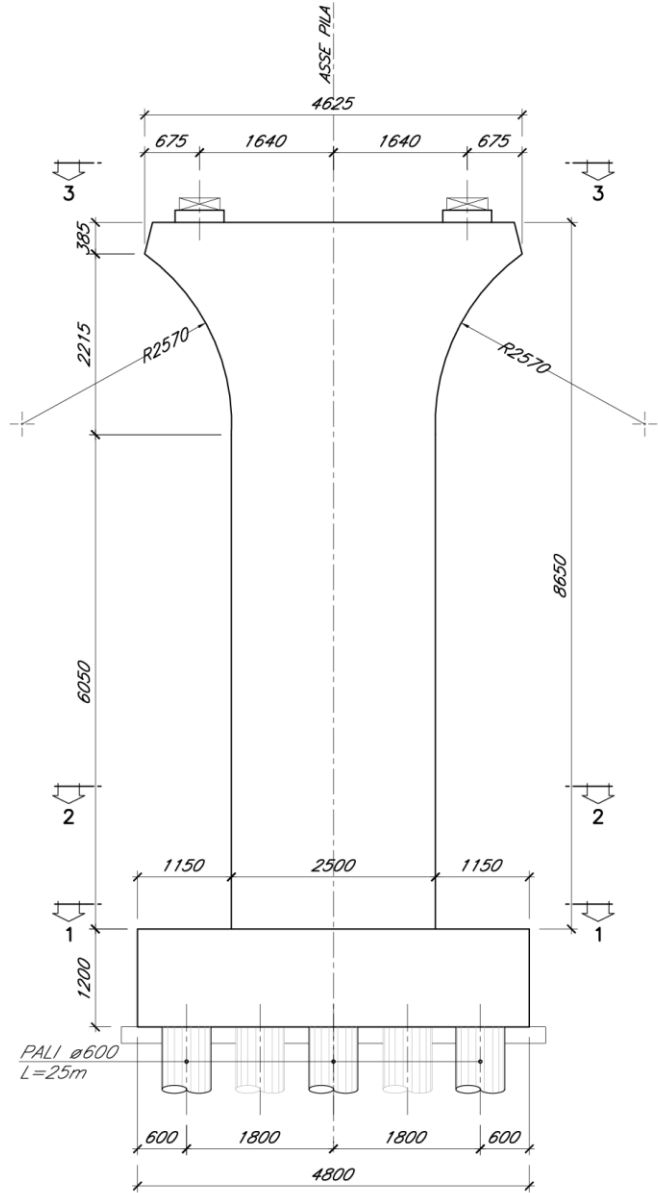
Elevazione pile 2 e 3 - Geometria [mm]
